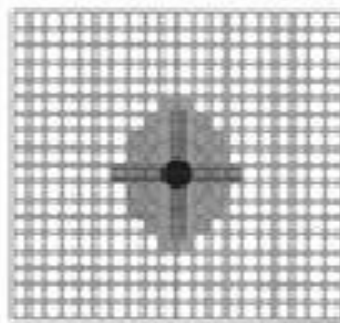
Esquema de intersección de columnas con losas Bubbledeck. [5]
